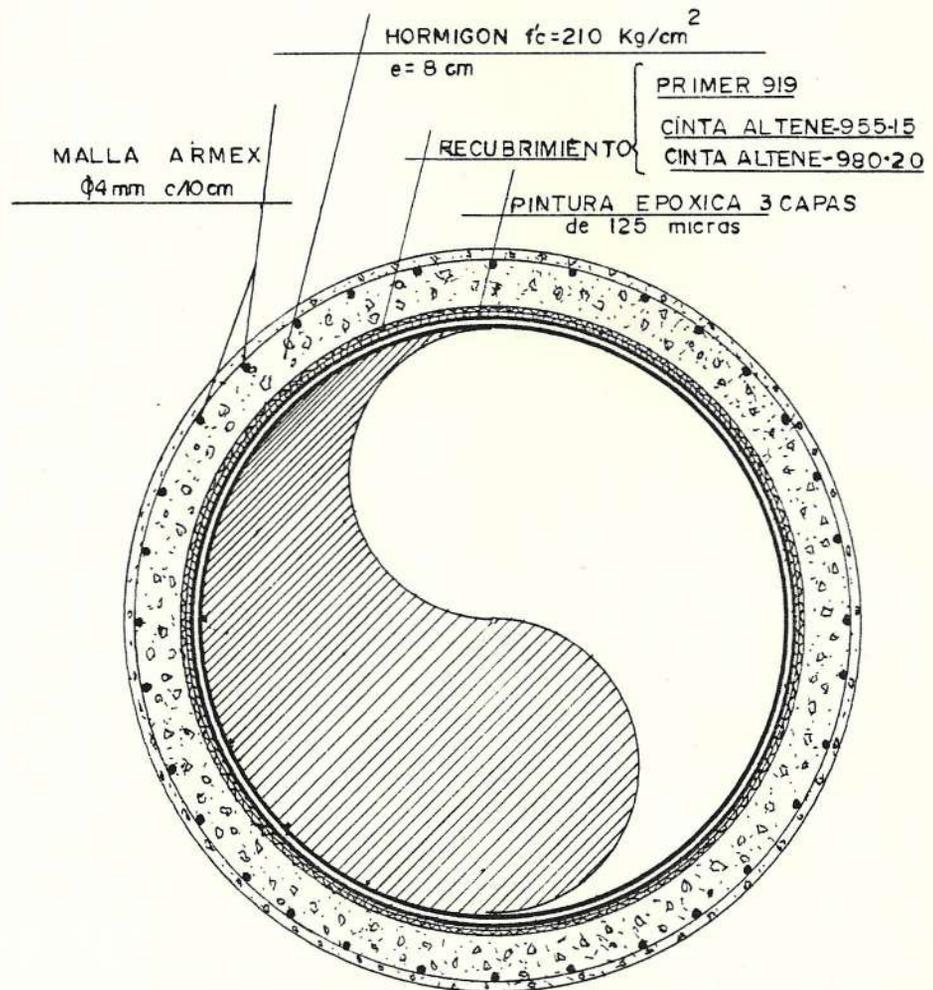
Detalle de sistema especial de protección y anclaje utilizado en zona fluvial.
